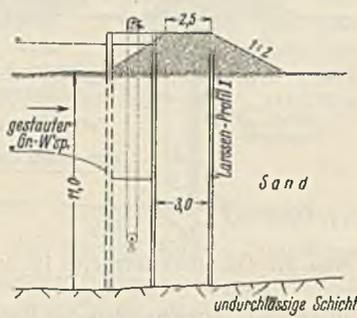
Grundsperrre mit zweifacher Spundwand.
